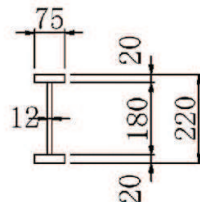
補助縦桁の断面形状 (単位 : mm)
